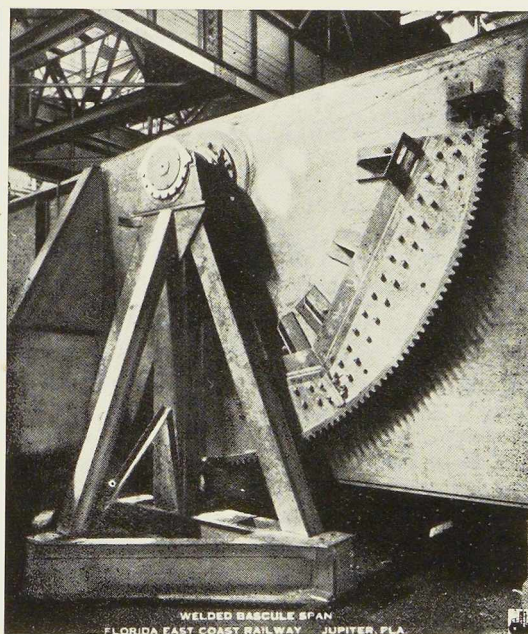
Montage à blanc en atelier. La photo, prise entre les deux maîtresses poutres, montre notamment l'assemblage de la caisse du contrepoids avec une poutre principale, ainsi qu'un des segments dentés.
